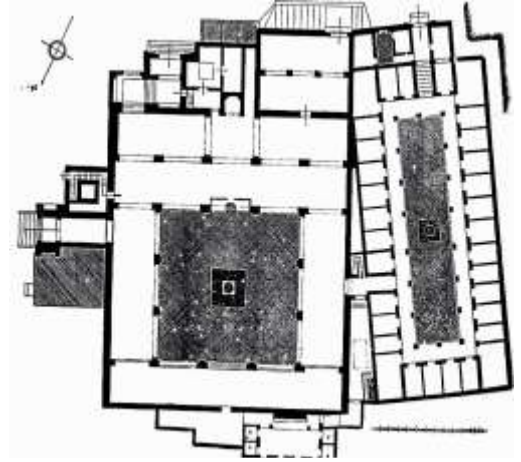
مسقط أفقي لجامع المدرسة البوعنانية
